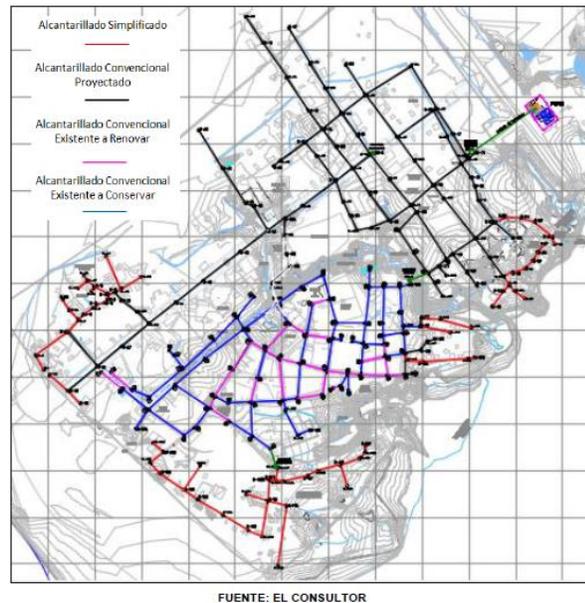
Esquema General del sistema de alcantarillado de Bajo Baudó
